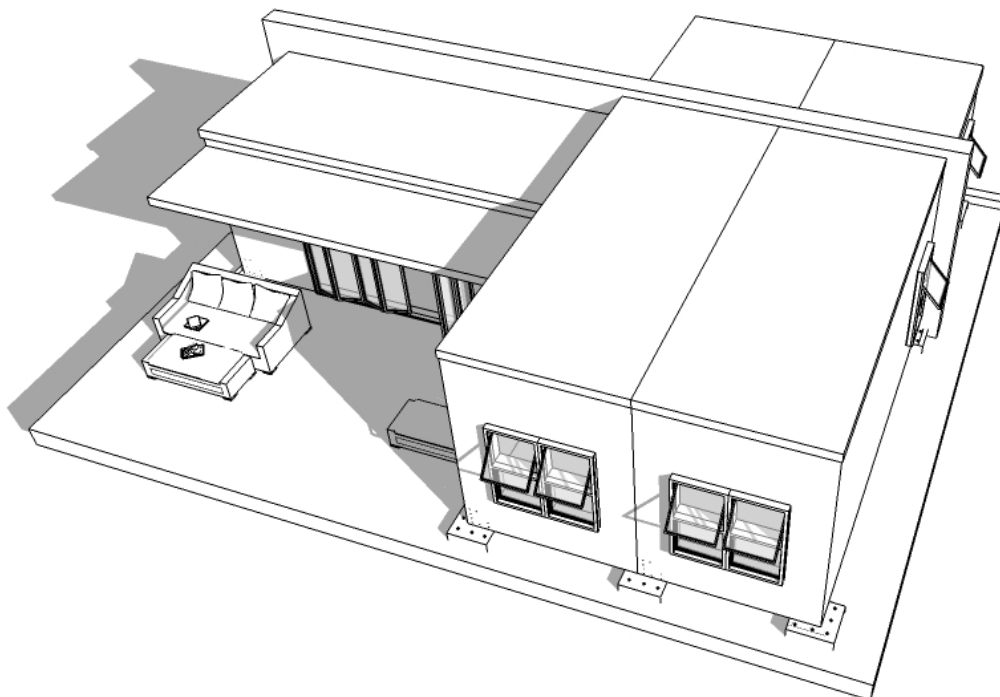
Sistema Modular Espacial. Vista. Fuente:
